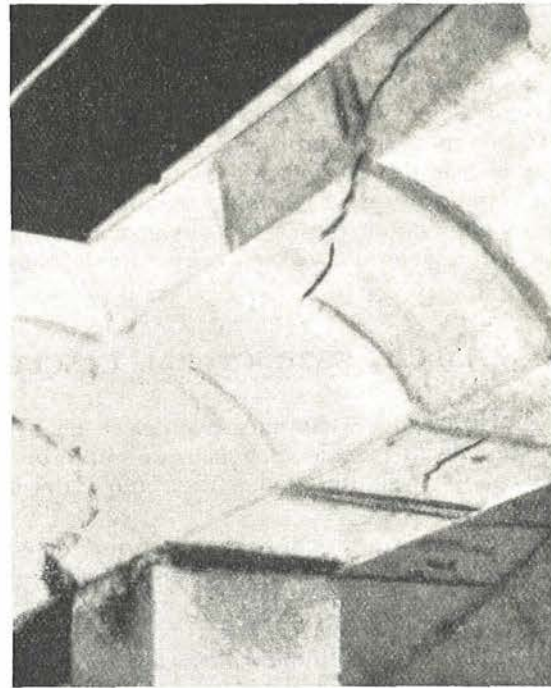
Viaducto de Hammersmith. Modelo de hormigón.
